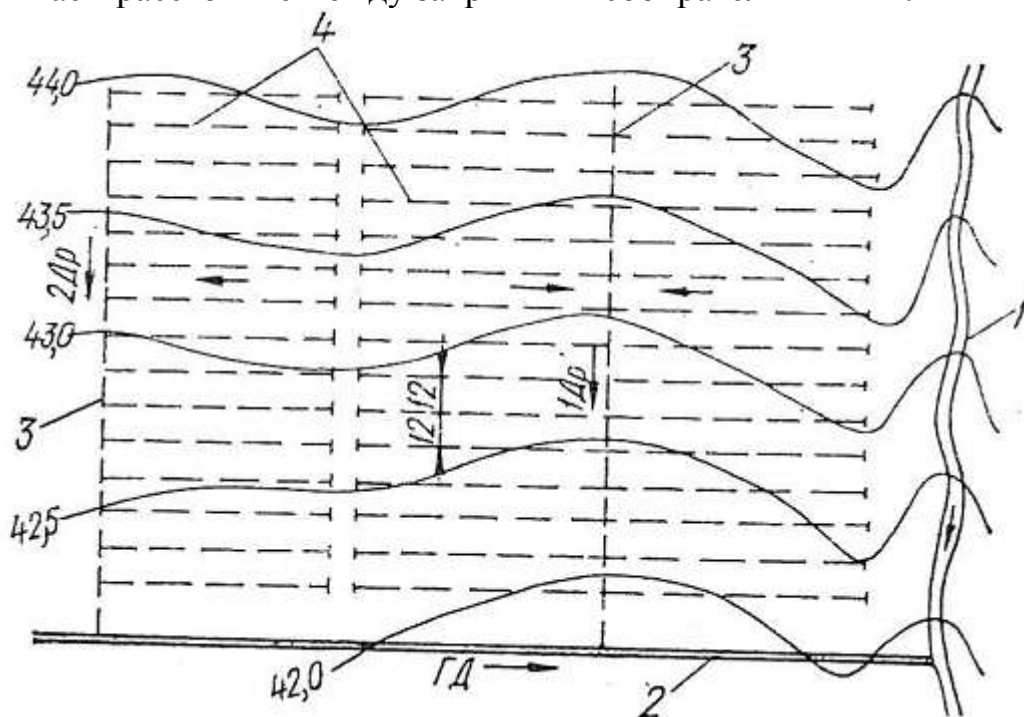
План сети при осушении закрытыми собирателями:
